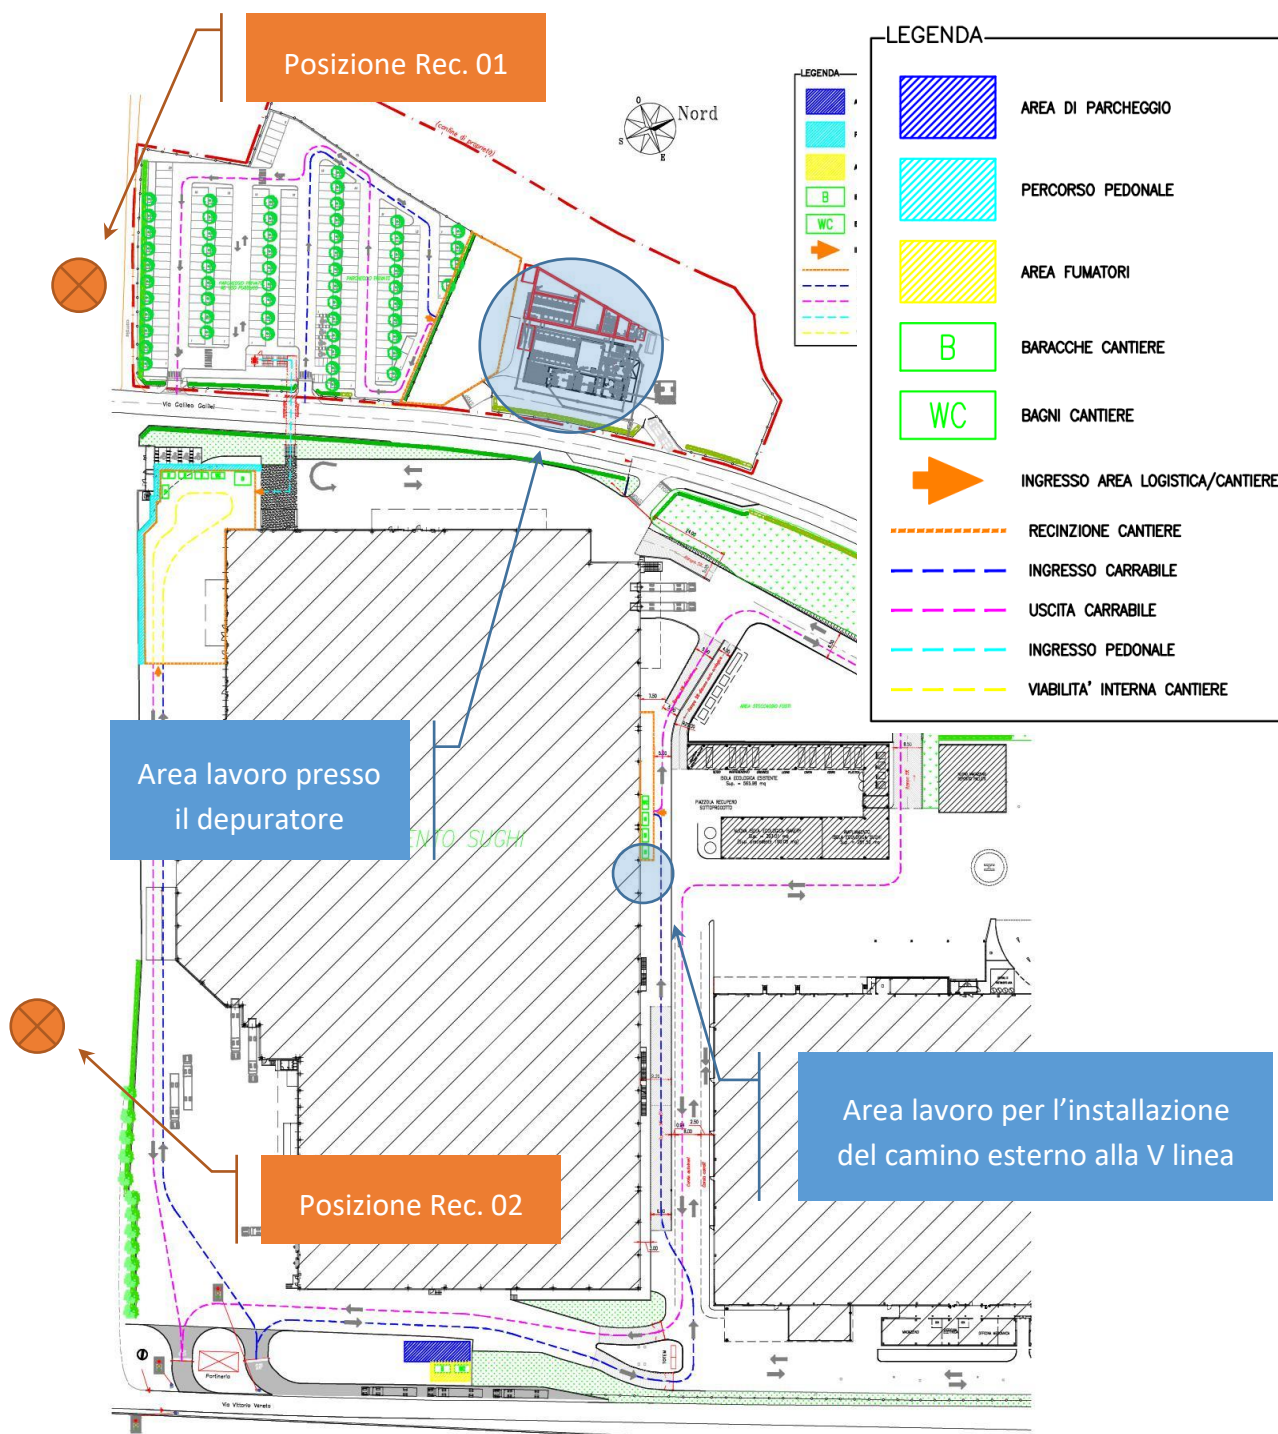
Planimetria piste di cantiere e aree lavorazione
